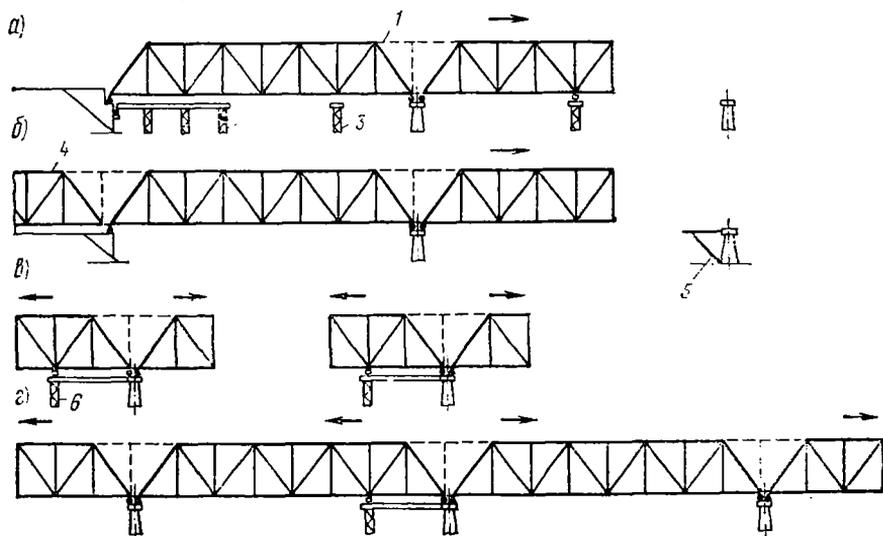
Схемы приведения пролетных строений к консольному виду:
